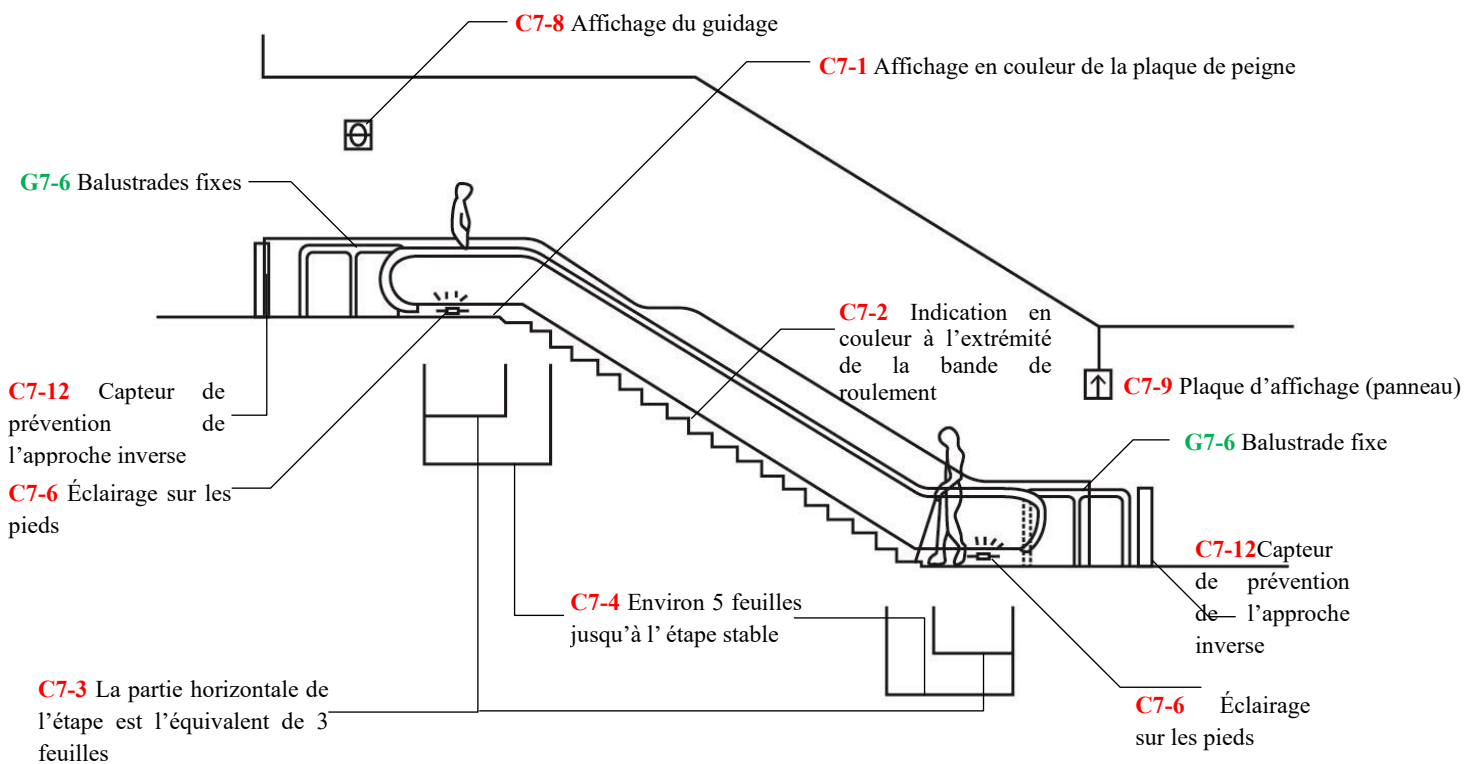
Exemple de plan d'escalator (section transversale)
